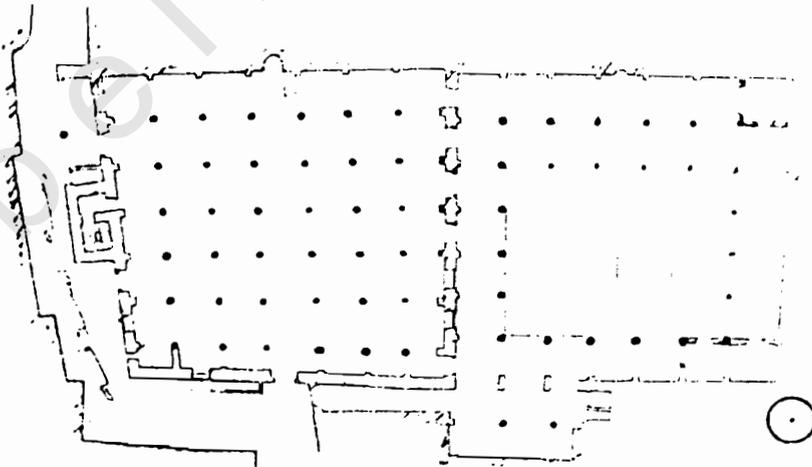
مسقط أفقي لمسجد بتليس عن أصلاناب .
